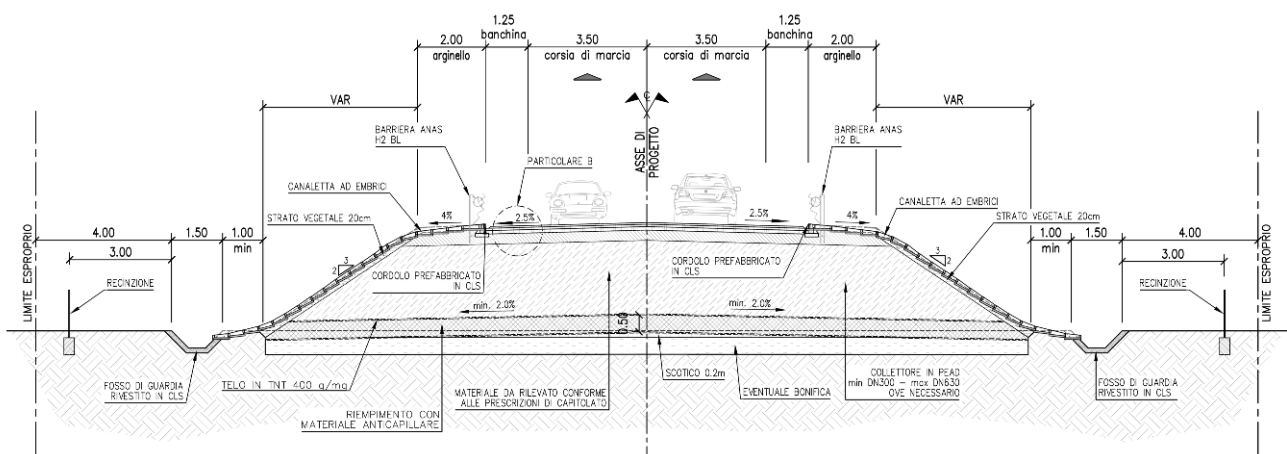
Sezione tipo in rilevato dell'asse secondario - Complanare Casic "Dorsale Consortile"
